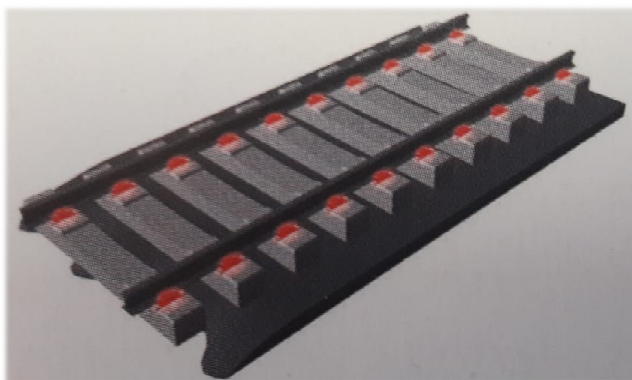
Sistemas con bloques o traviesas sobre hormigón o asfalto
